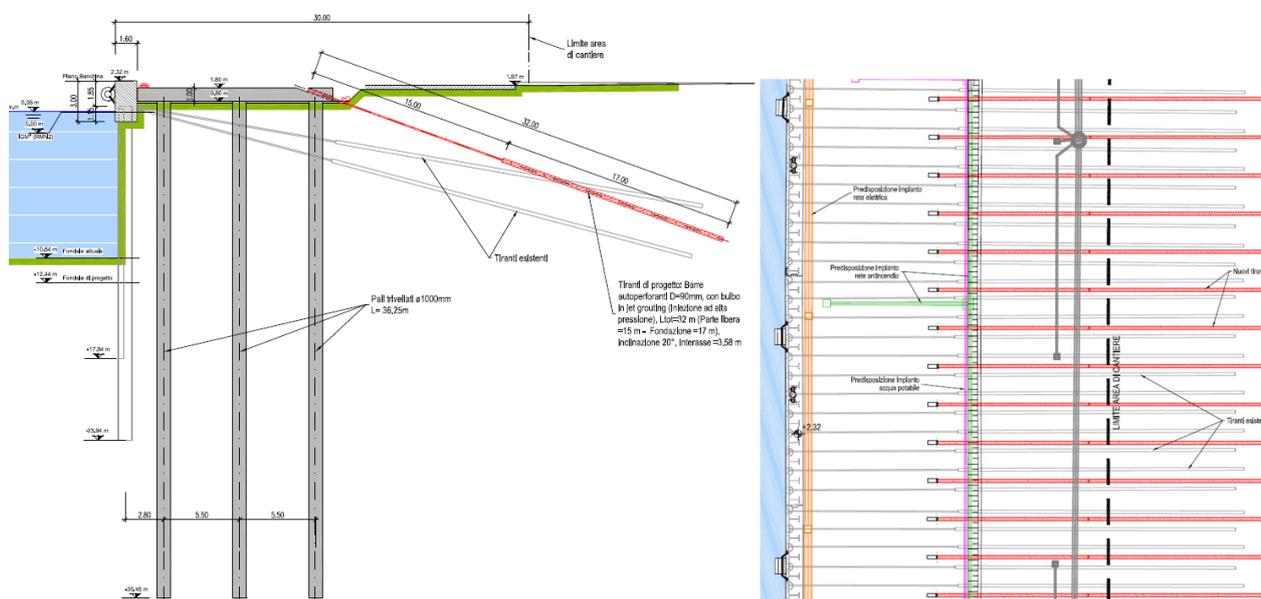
Banchina Trattaroli Nord – Fase 7 – Sezione e planimetria
